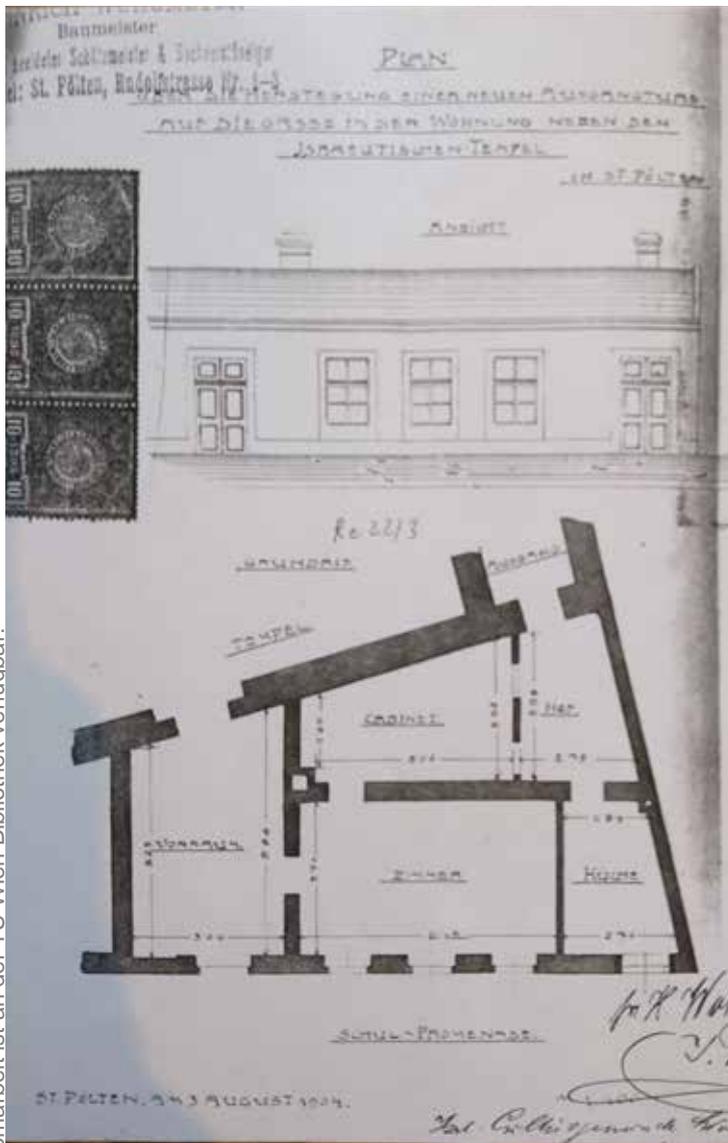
Grundriss und Ansicht, Alte Synagoge 1904
